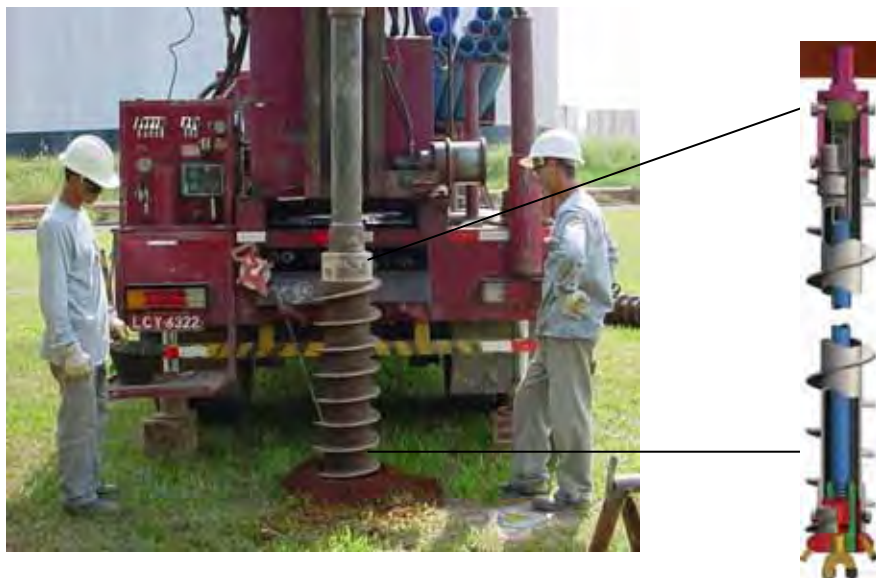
Caminhão com equipamento do tipo hollow stem auger, no detalhe desenho do trado oco.
